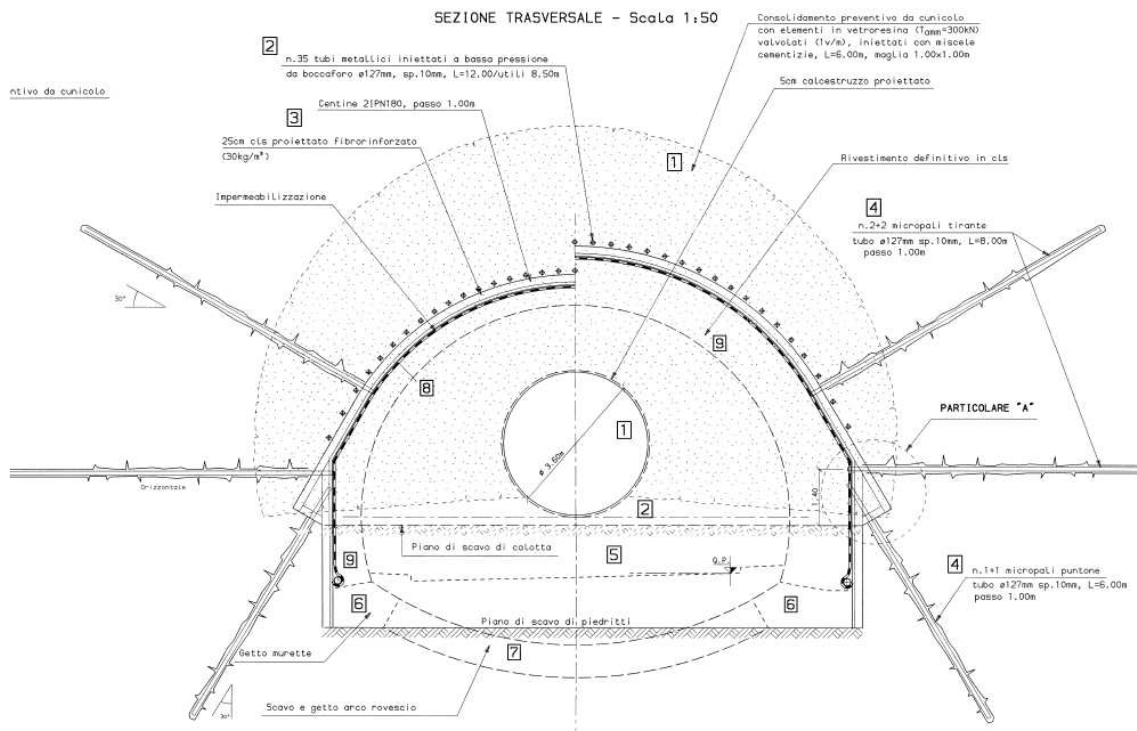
PE GEODATA 1996 – Galleria Guinza - Sezioni Tipo F – Sezione di scavo
